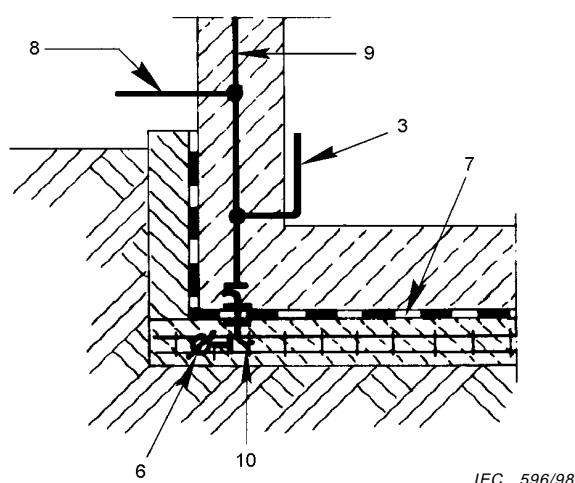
Conducteur de liaison entre la prise de terre à fond de fouille et la barre d'équipotentialité traversant la couche bitumée isolante
